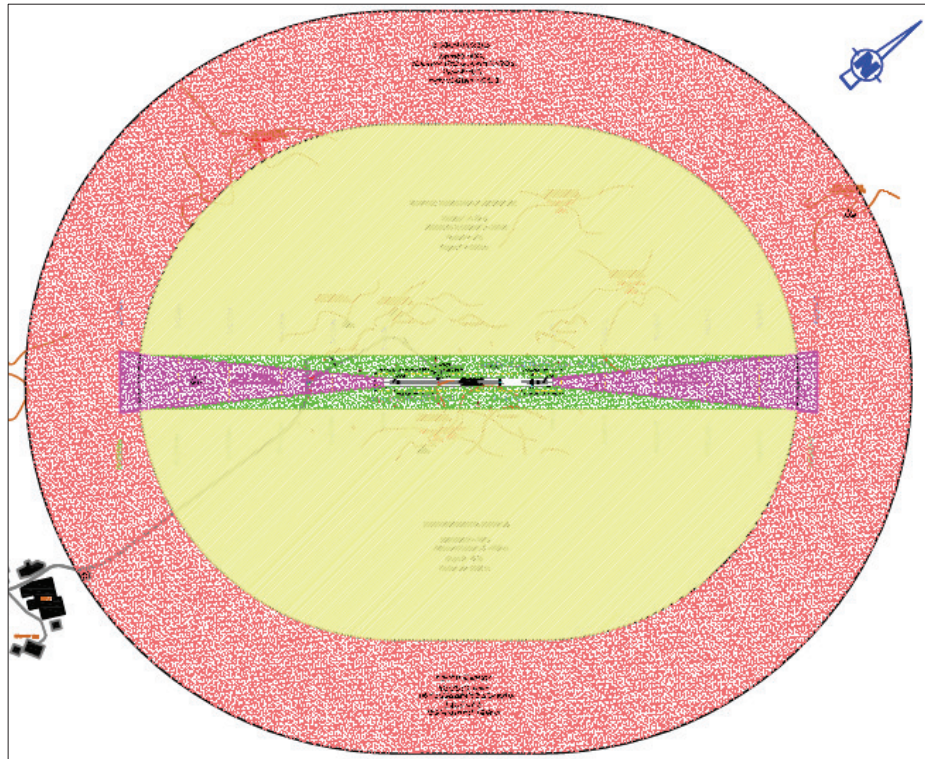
PLAN DE DEGAGEMENT DE LA PISTE 04/22
